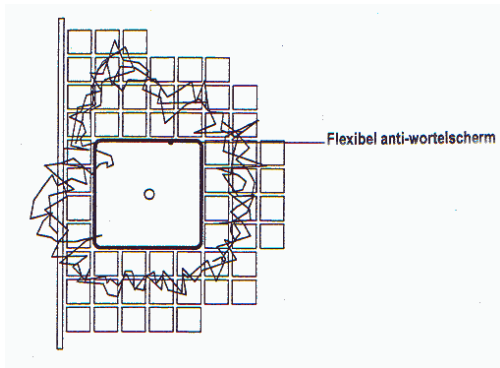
detail 2b – gecontroleerde barriërvorming voor diepe wortelgroei
